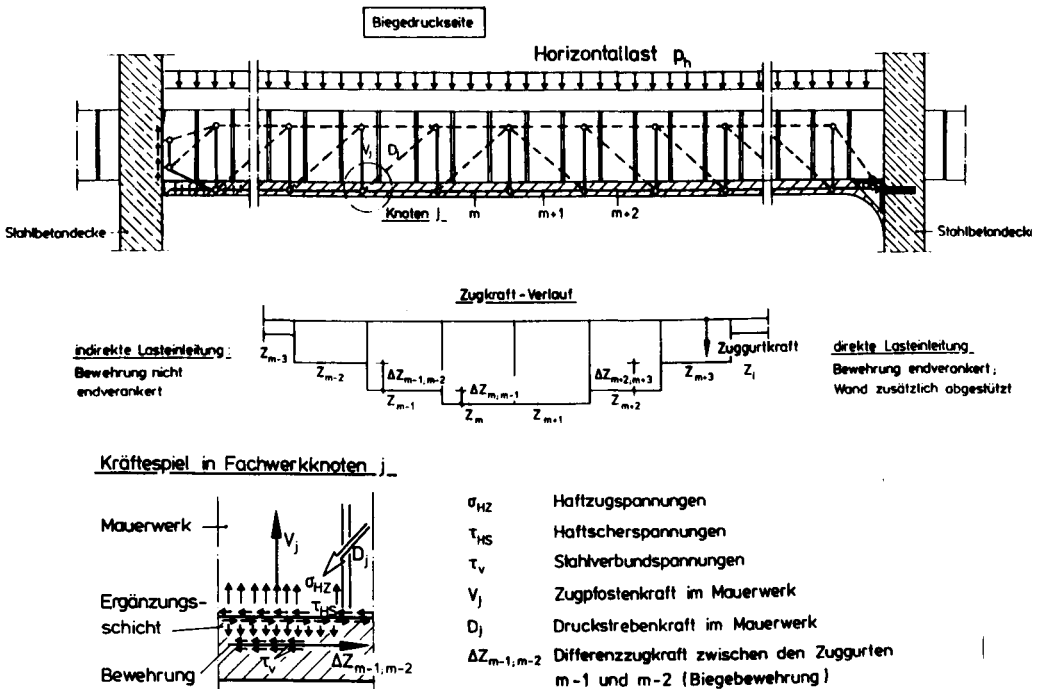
Fachwerkmodell zur Beschreibung des Tragverhaltens flächenhaft verstärkter Mauerwerkswände (Mauerwerkswand liegend dargestellt)
